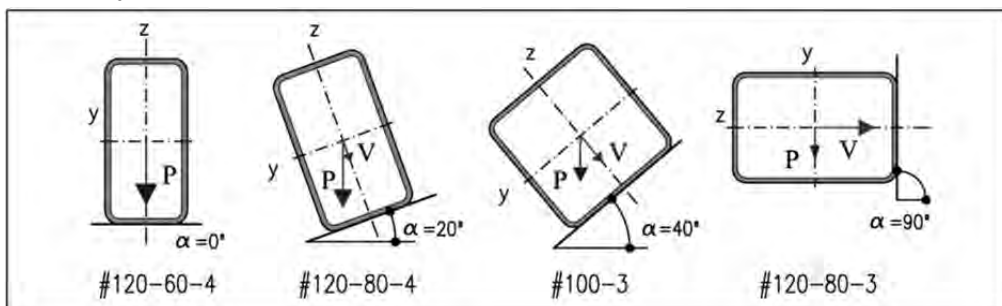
Perfil rectangular y ángulo de la cubierta
